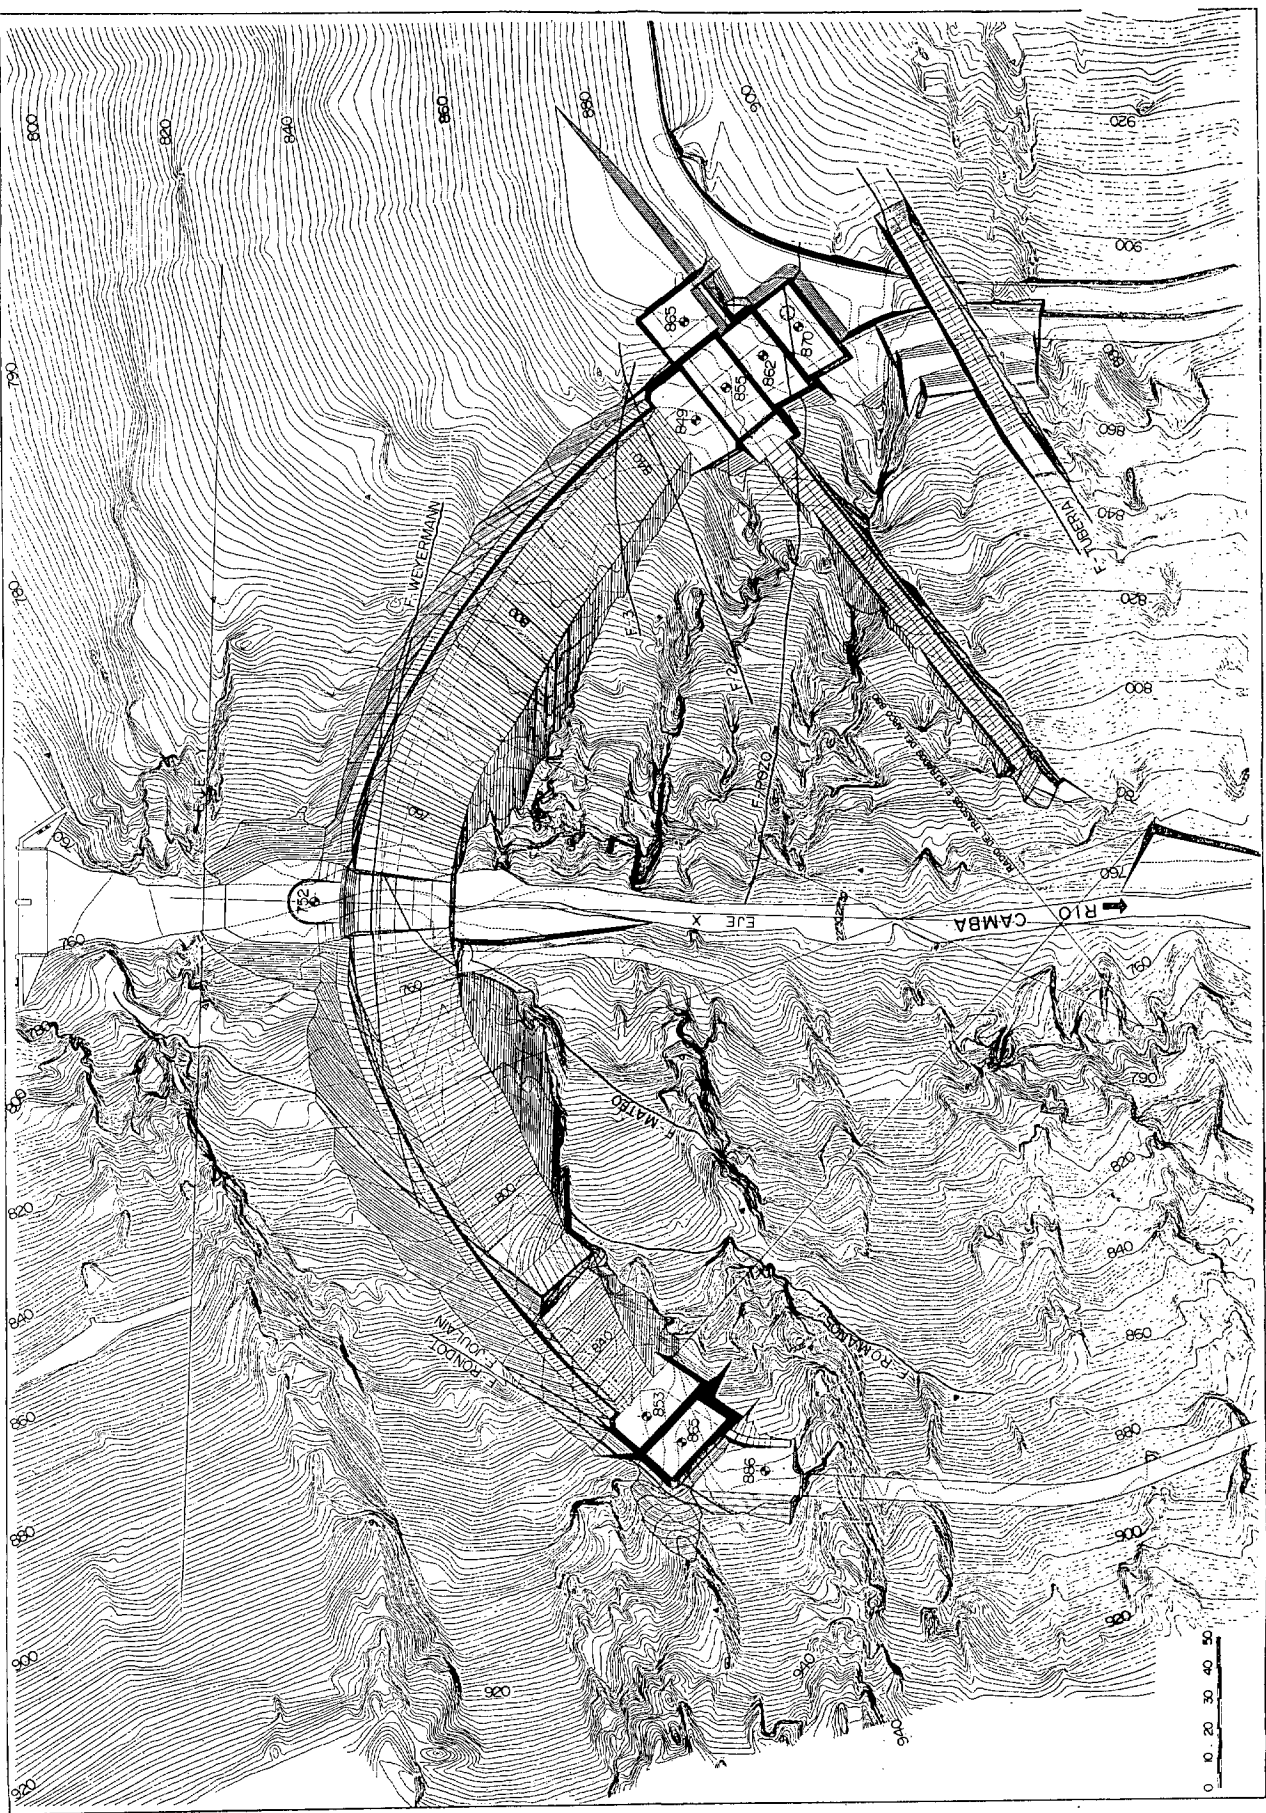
Plano de excavación definitiva con situación de fallas.
